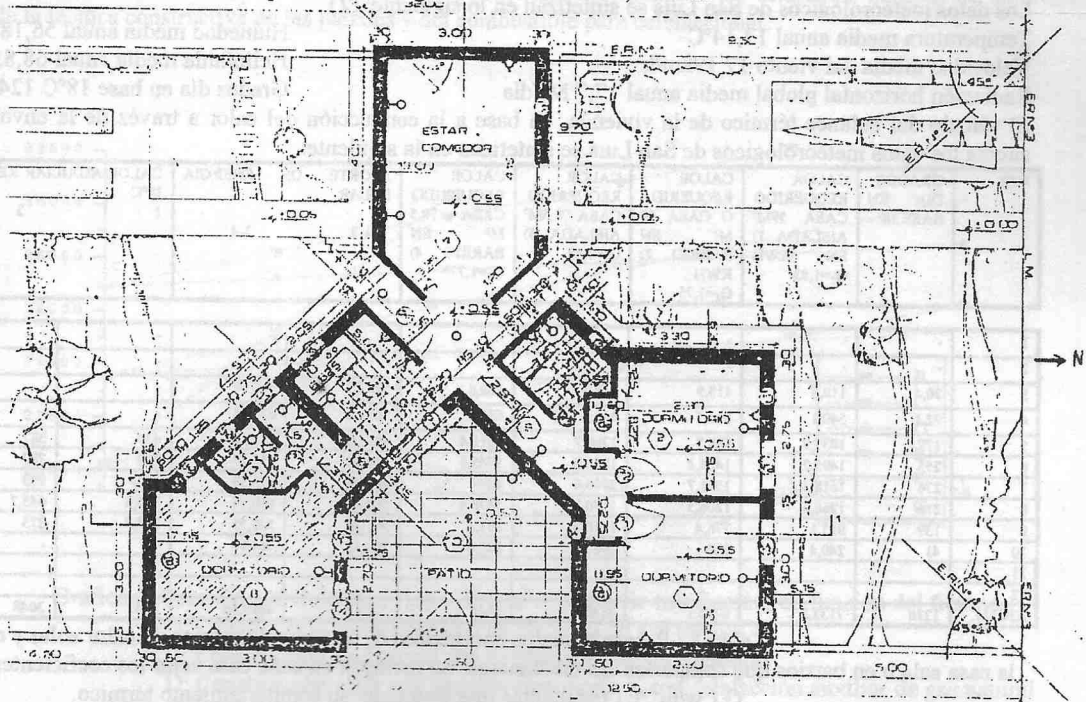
Plano de Planta de la vivienda, con el N a la derecha. Se ve la división del núcleo base y la ampliación.
